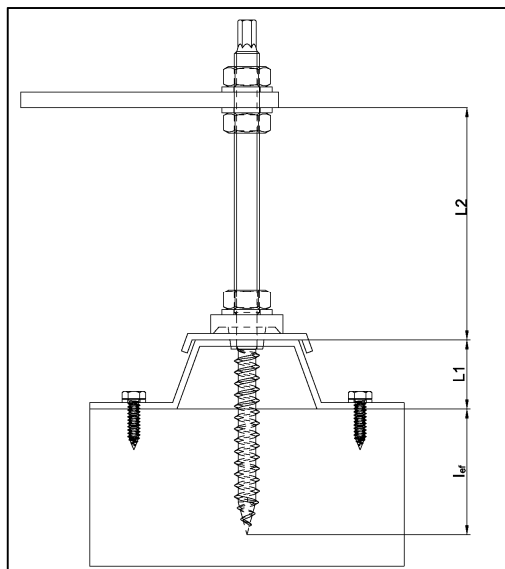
Befestigung der Stockschrauben auf Profiltafeln
